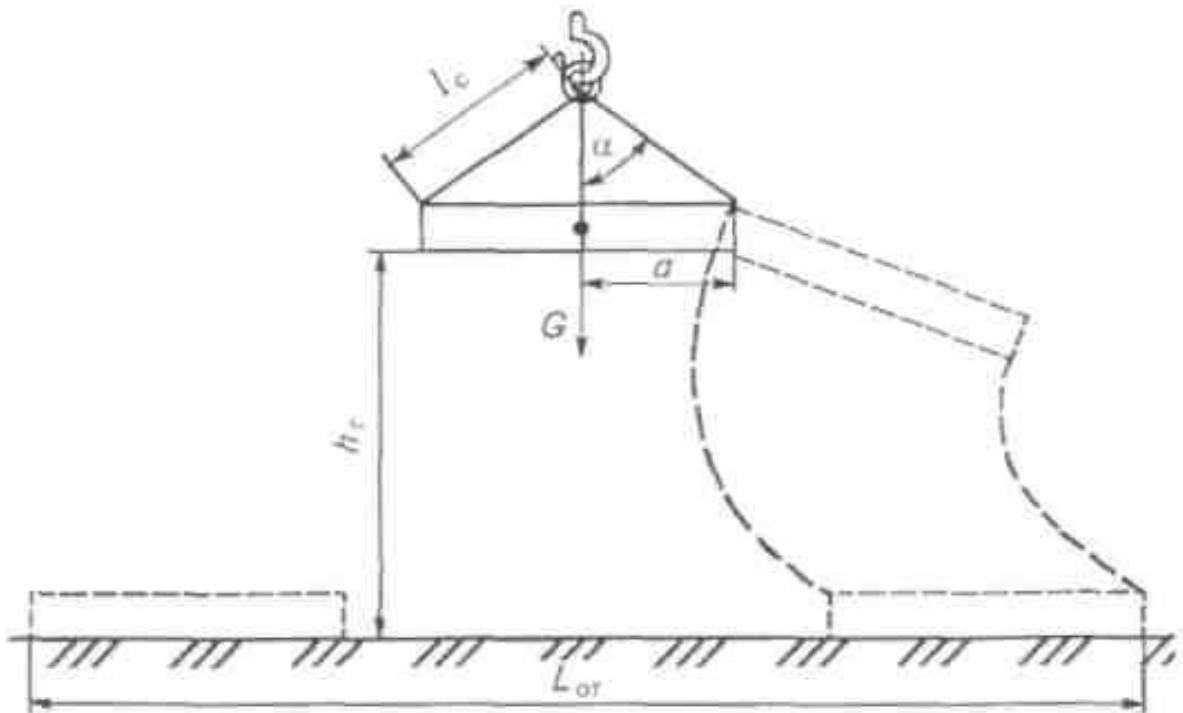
Схема определения границ опасной зоны при обрыве стропа ГПМ
